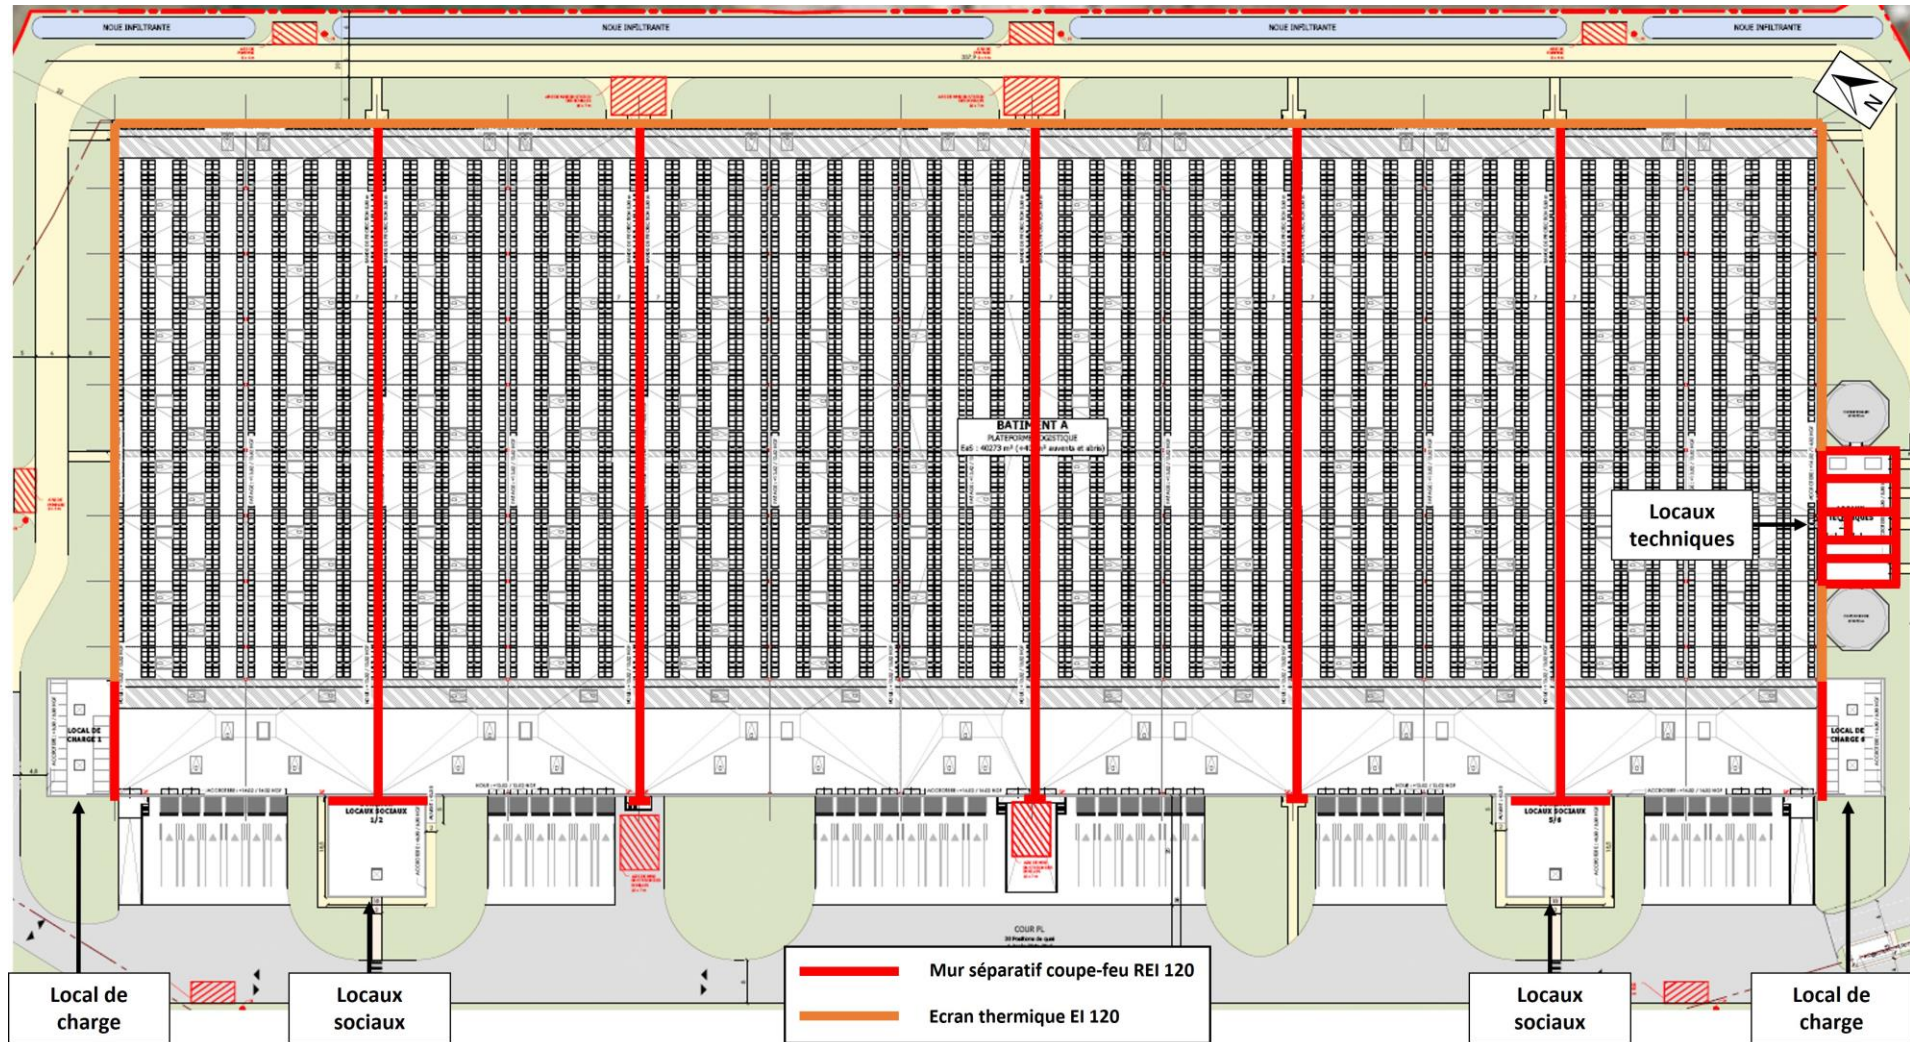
Localisation des murs et parois coupe-feu du bâtiment
